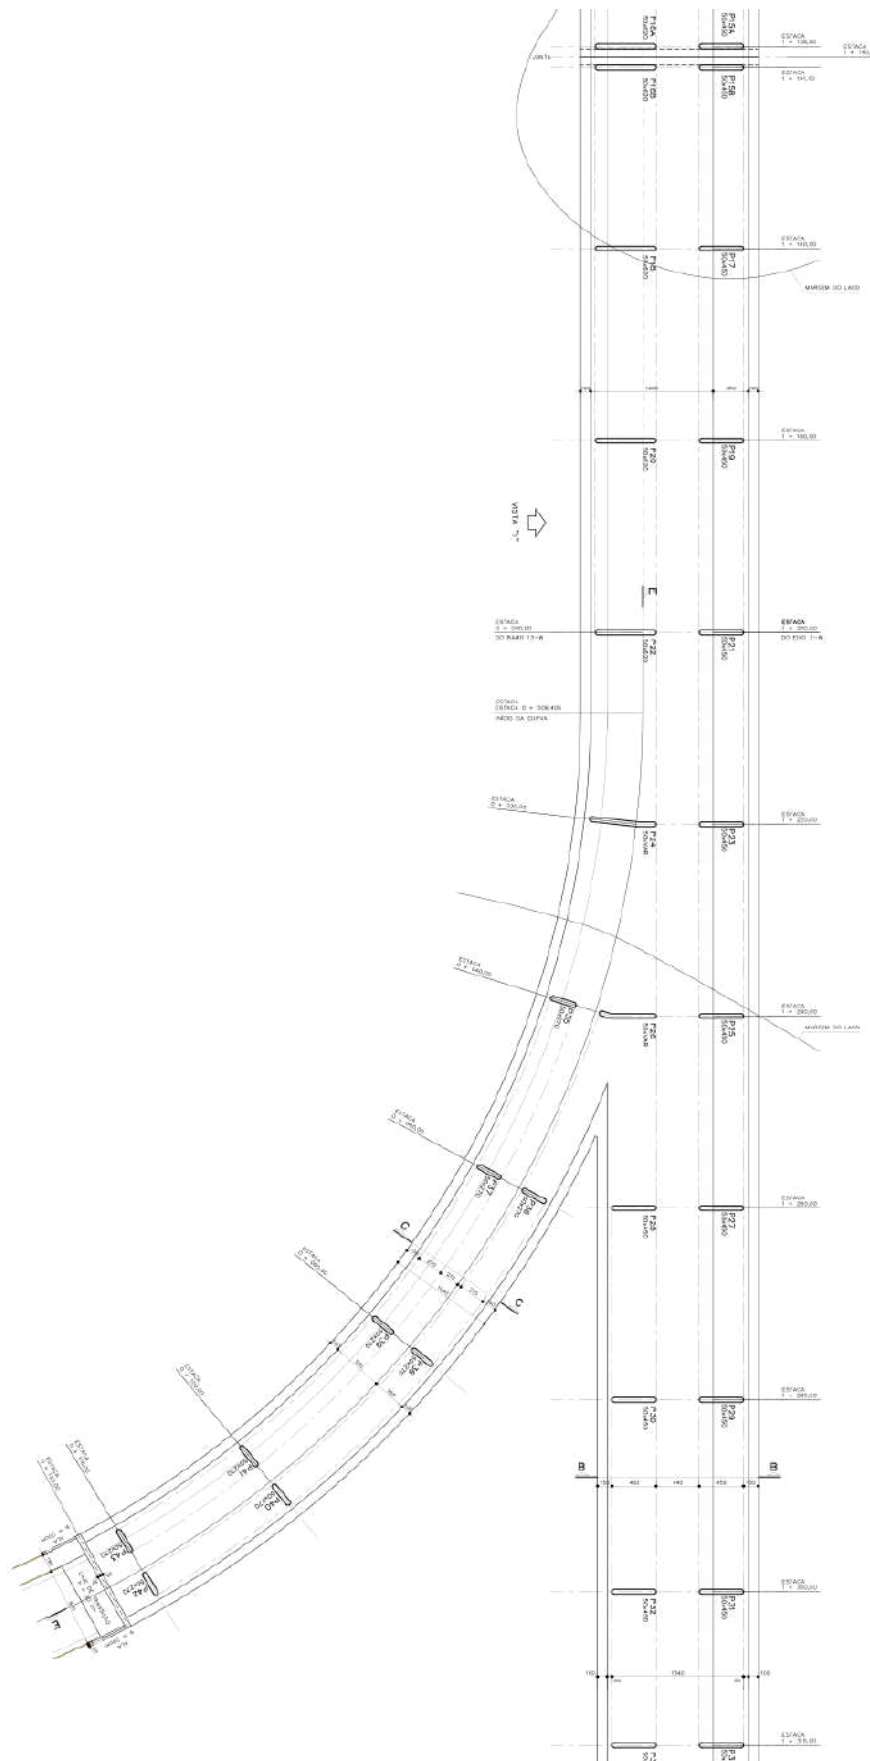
Eixos estruturais dos pilares da OAE 07, TTN. Fonte: DER/DF.
